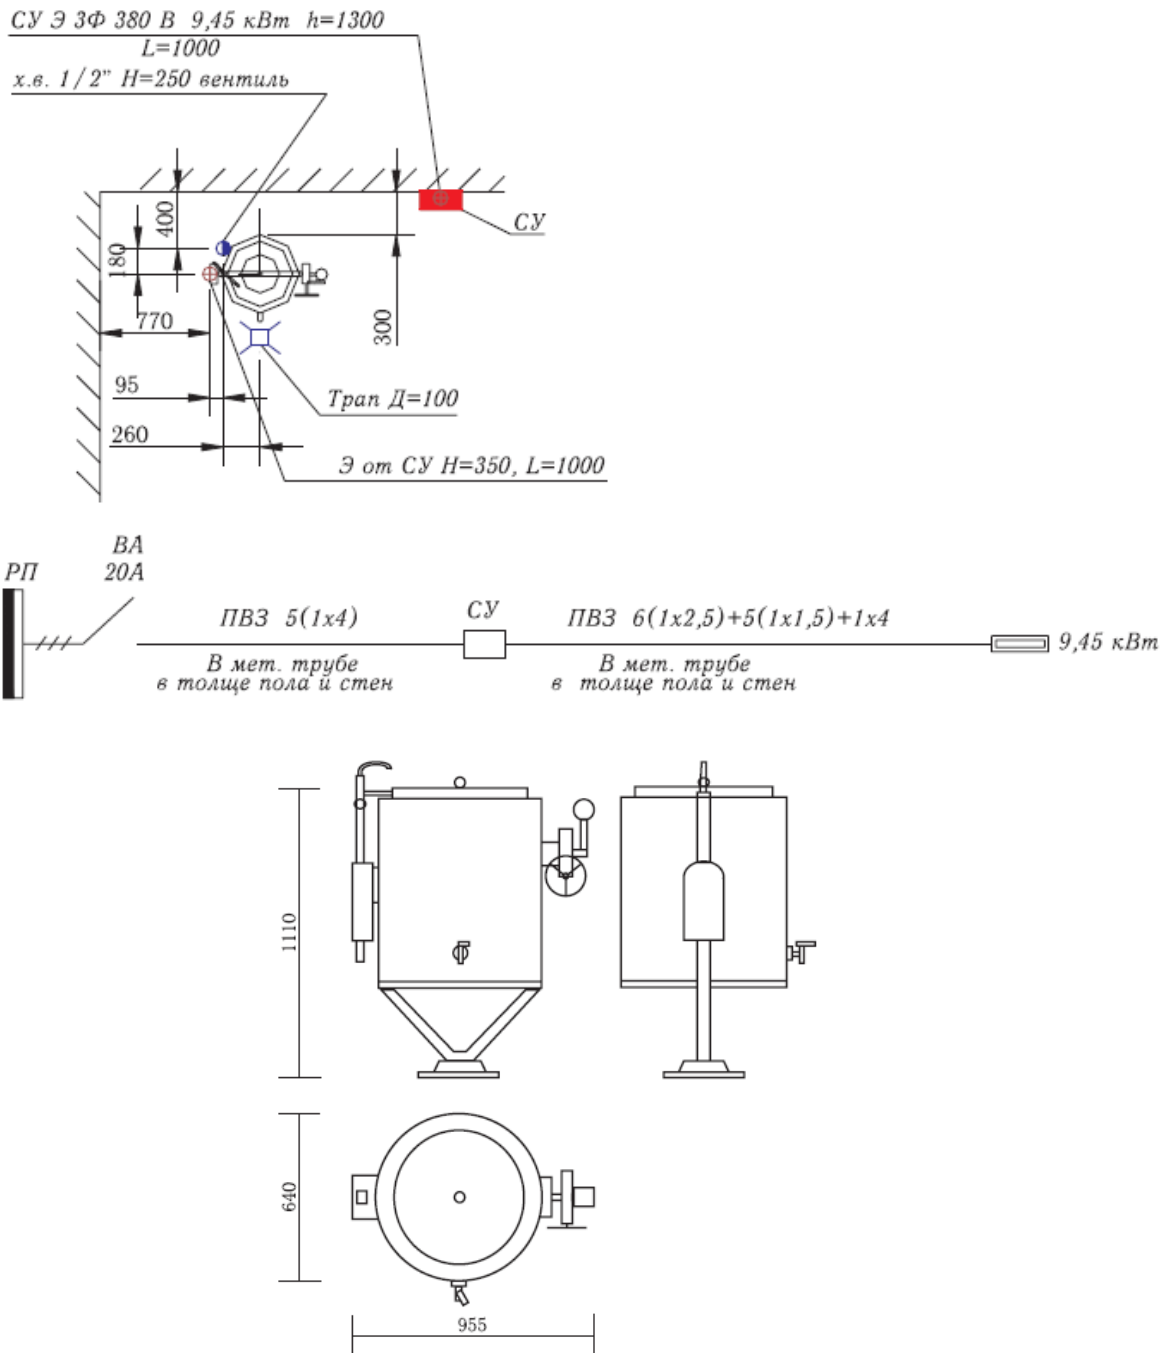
Схема подключения и габаритные размеры котла пищеварочного КПЭ-60
